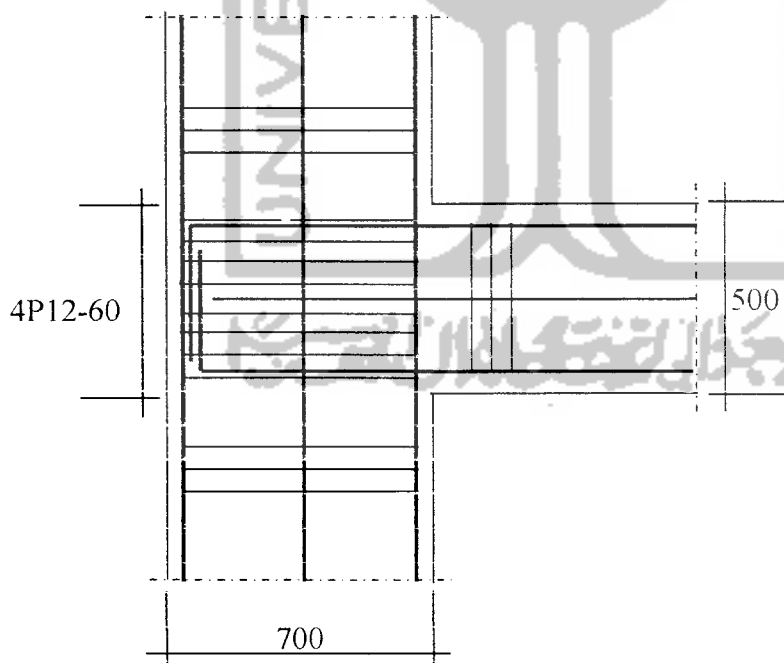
Detail Joint Balok-Kolom D Lantai 12
